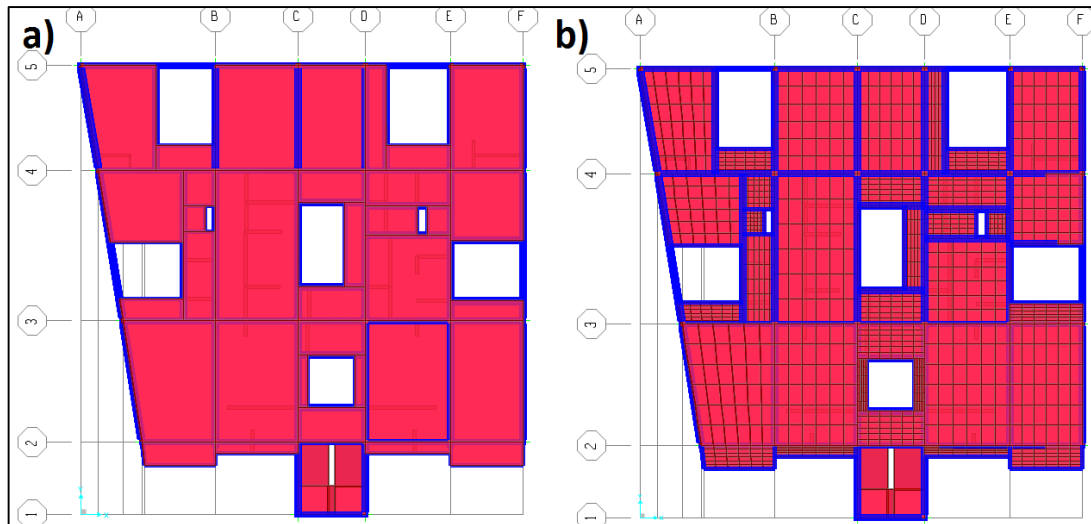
Ejemplo estructuras con losas refinadas. (A) Tipo de plano A, (b) Tipo de plano B.
